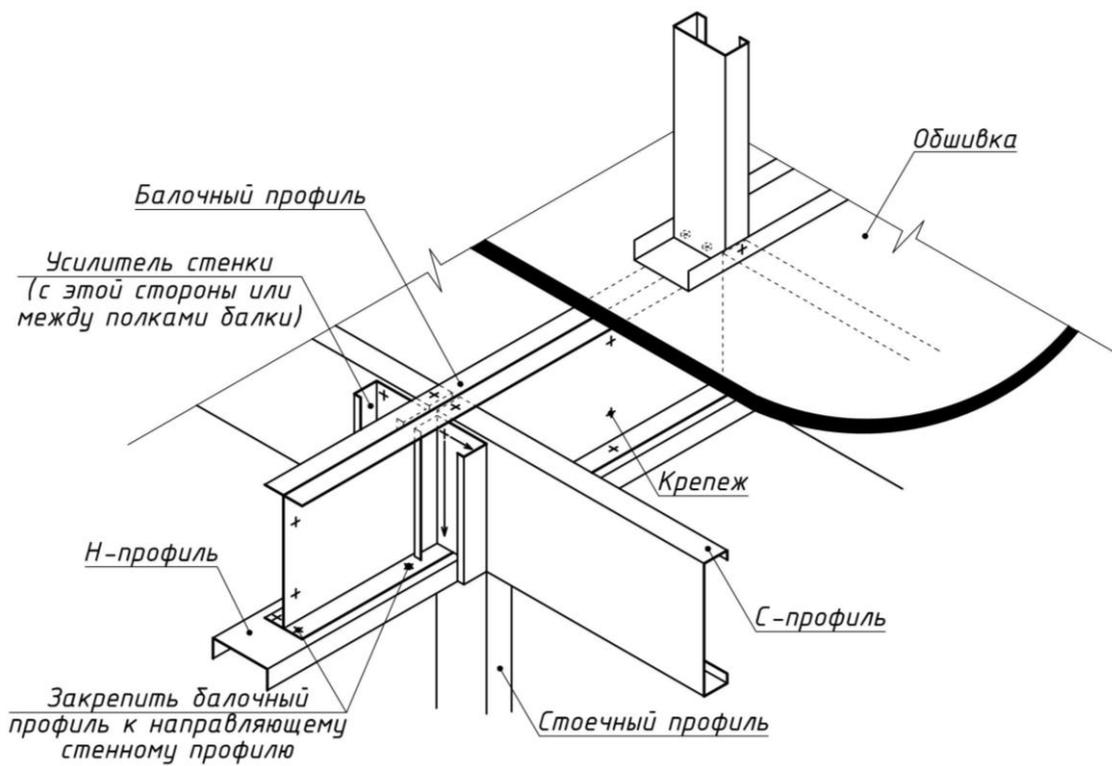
Узел П 10. Крепление перекрытия к внутренним несущим стенам
